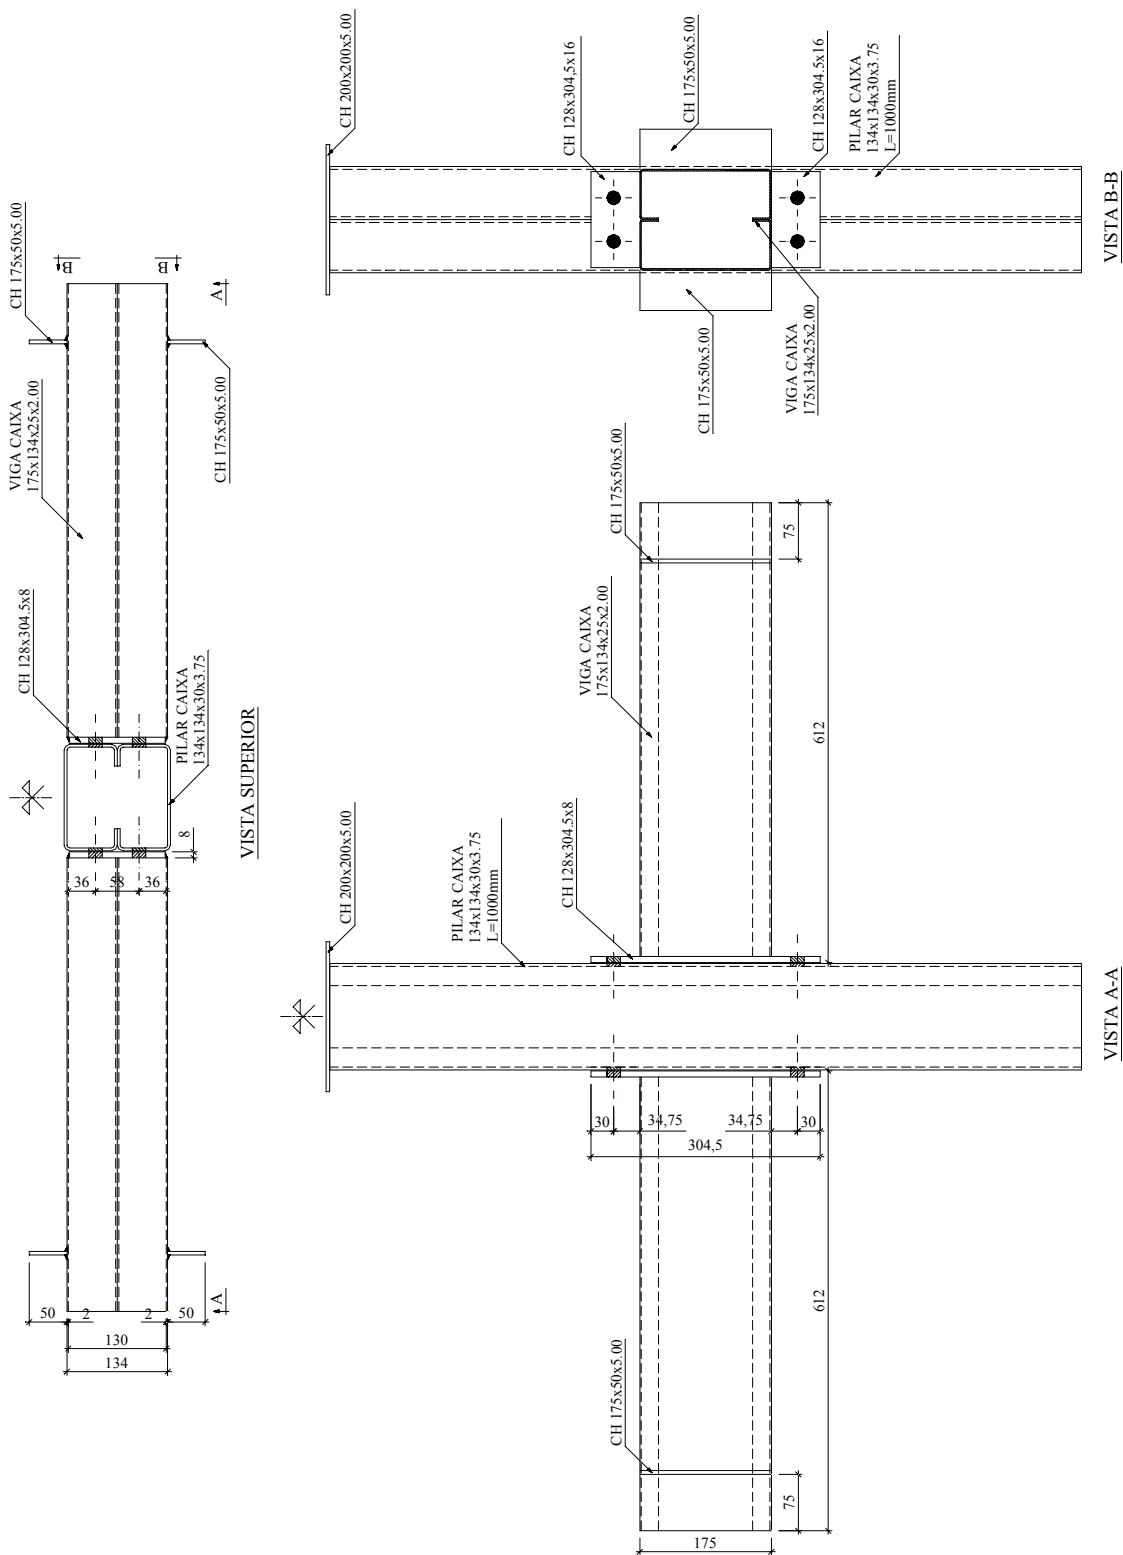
Ligação 01BF: flexível na maior inércia do pilar.
